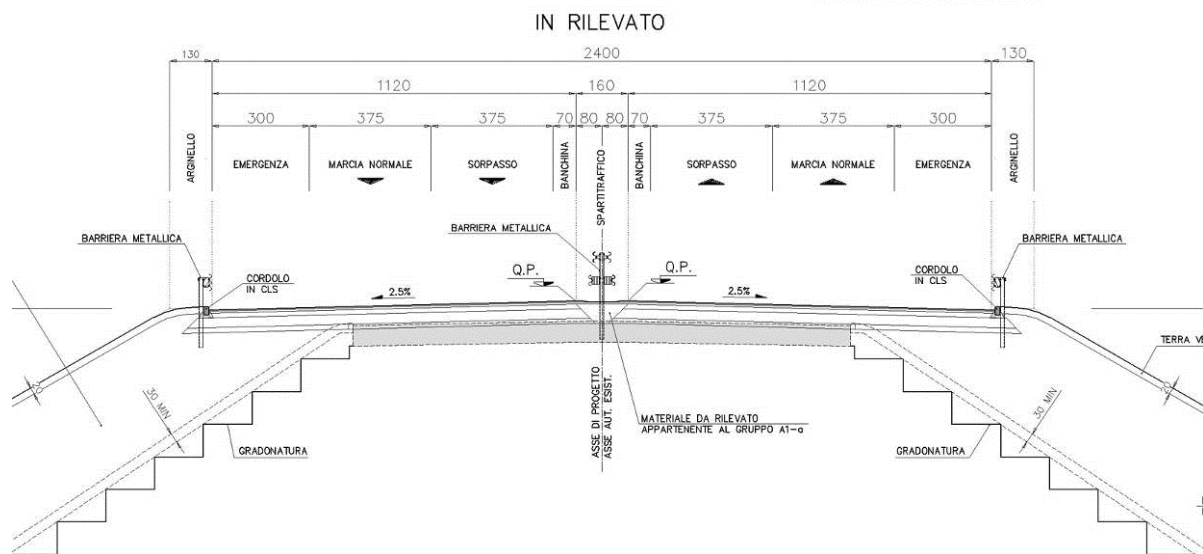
Sezione tipo di progetto (adeguamento simmetrico Variante SS1 Aurelia)
